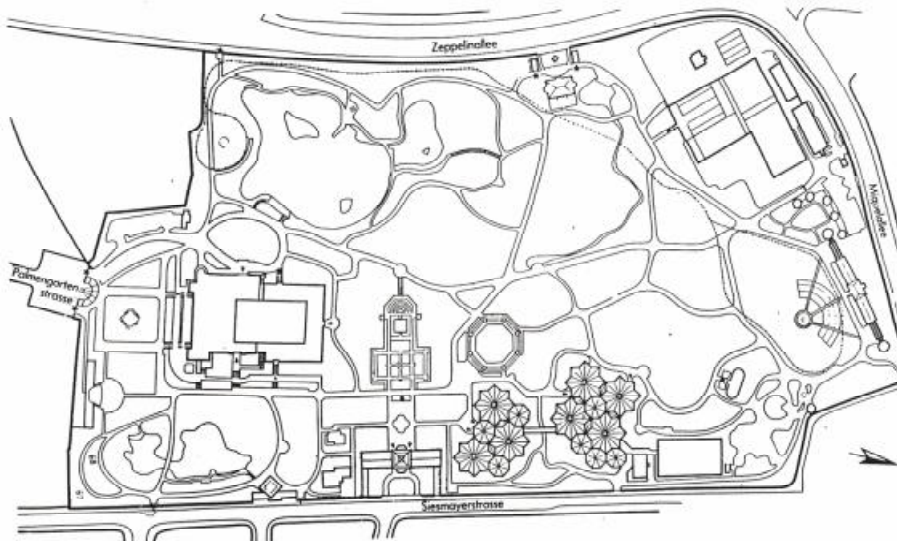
Lageplan Palmengarten Frankfurt a.M.
